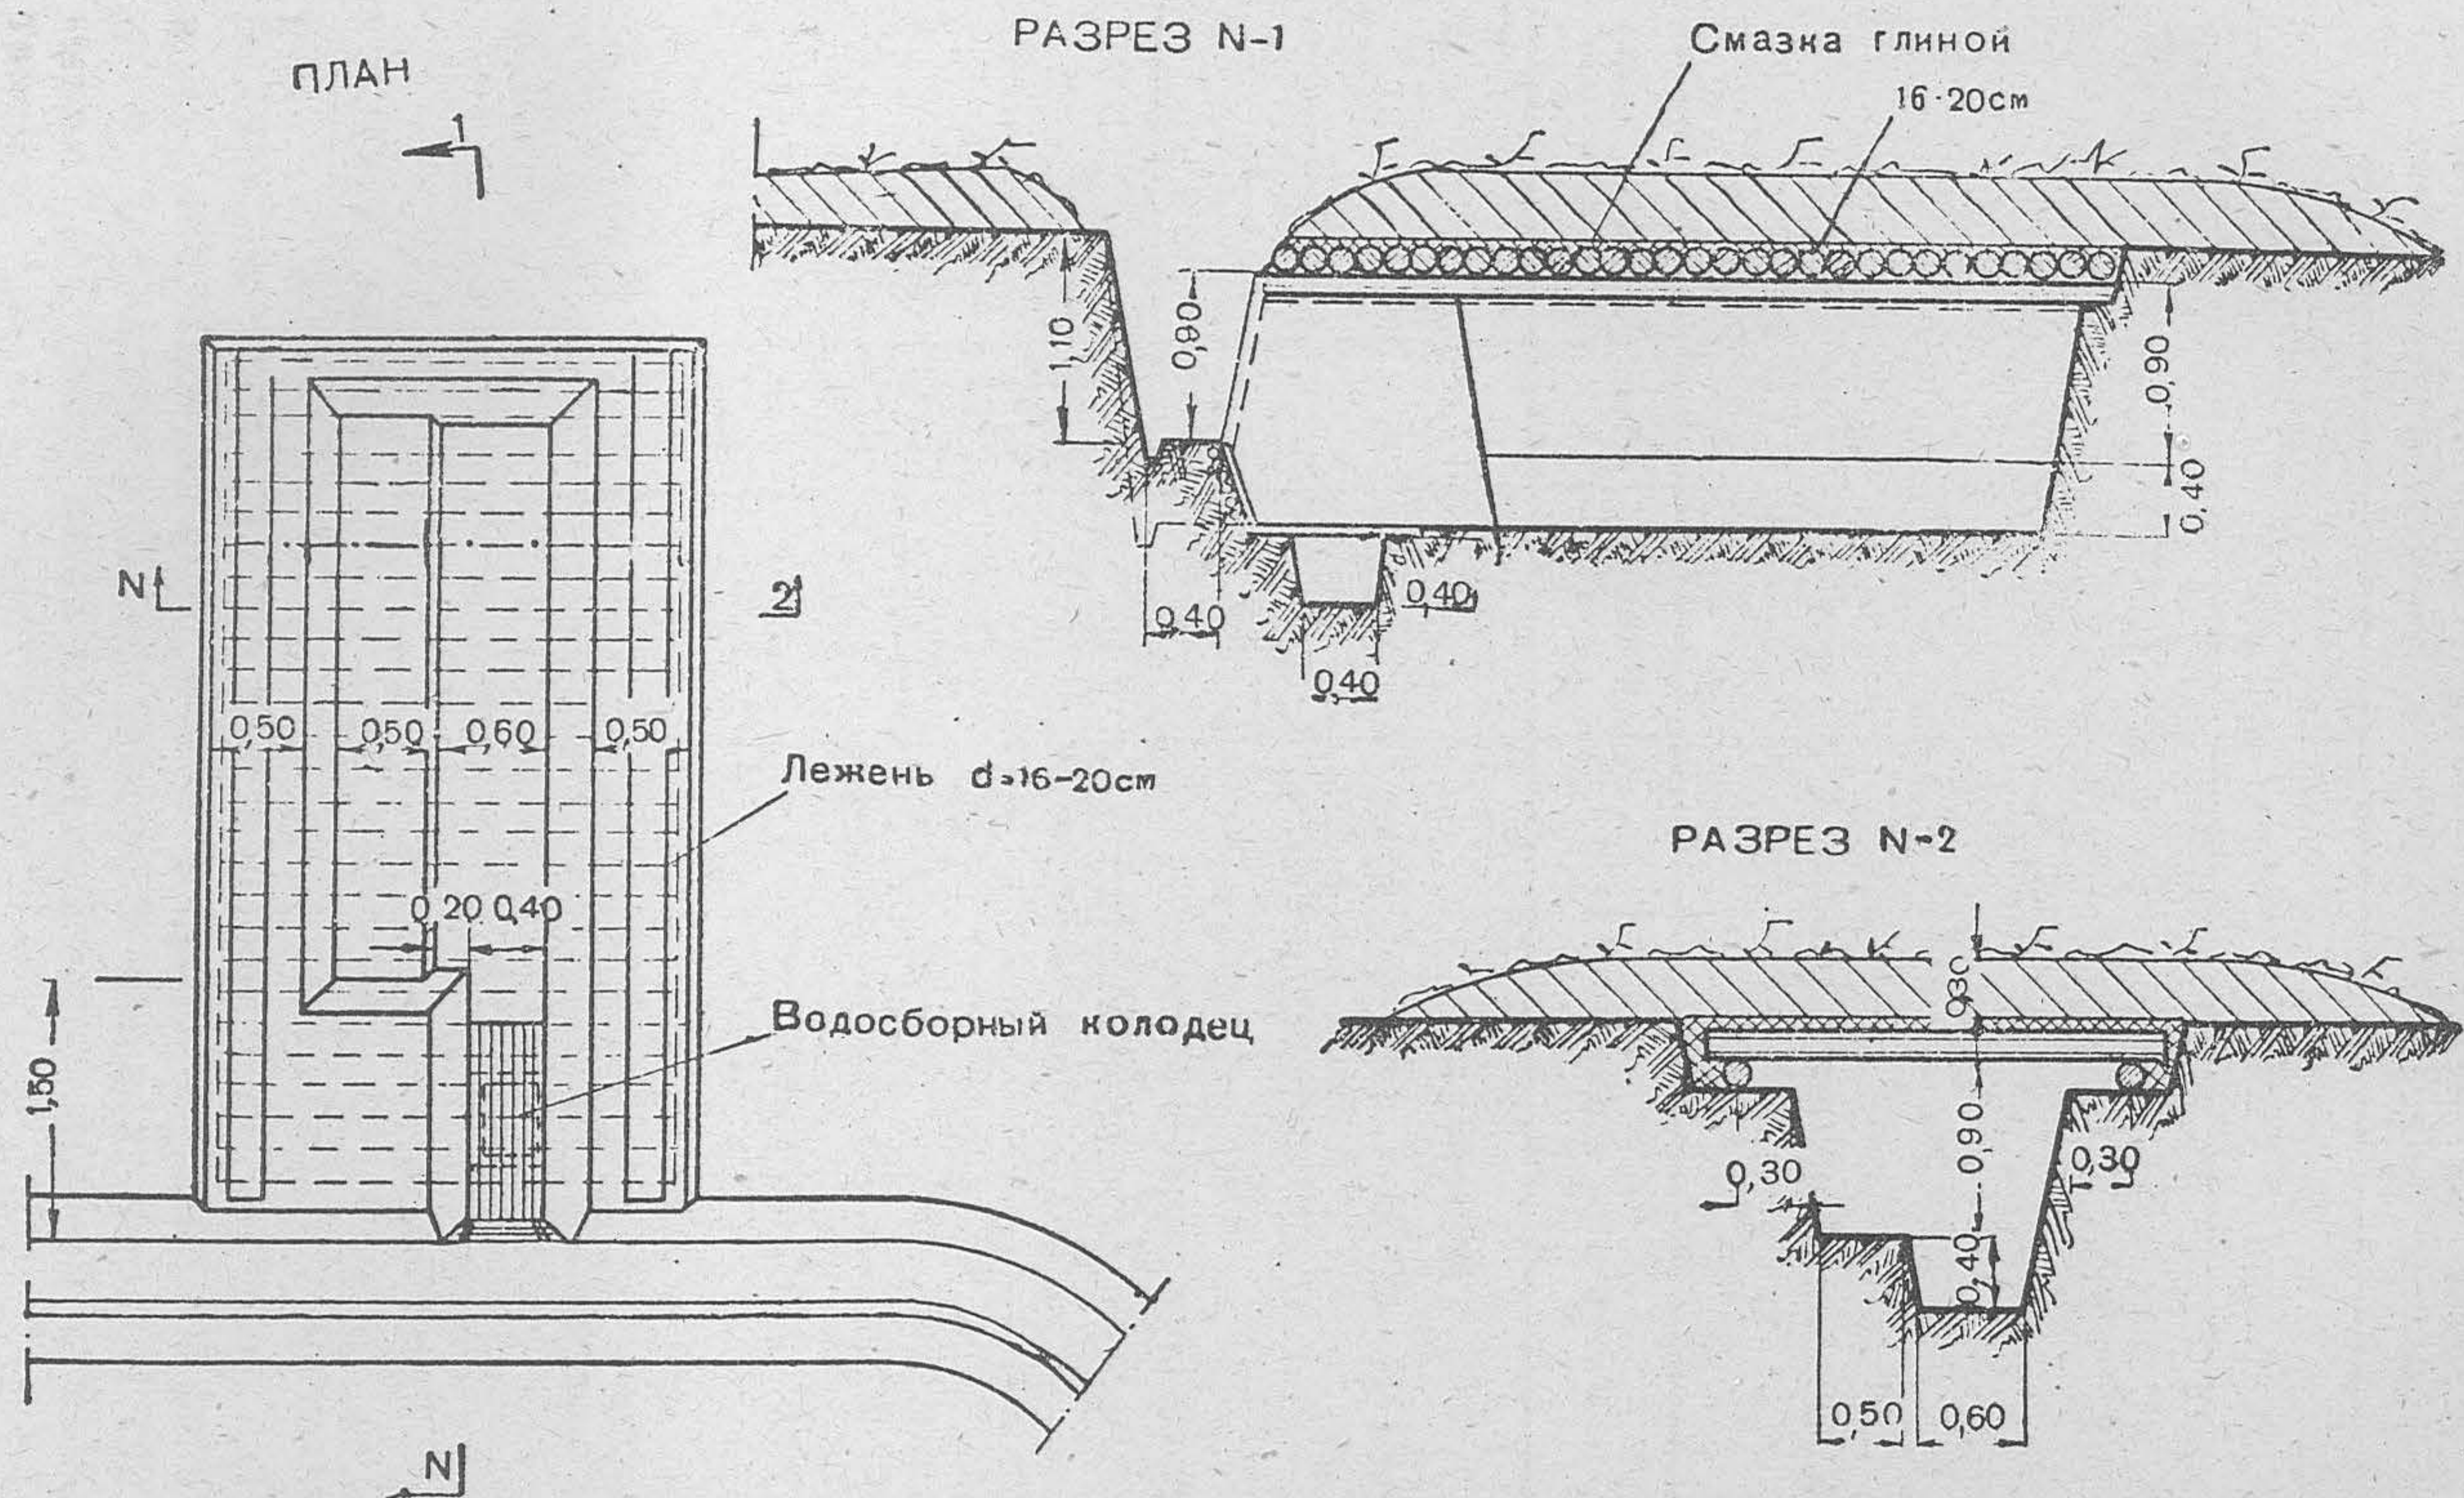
Подбрустверный блиндаж лёгкого типа для четырех-шести бойцов, размещающихся сидя
